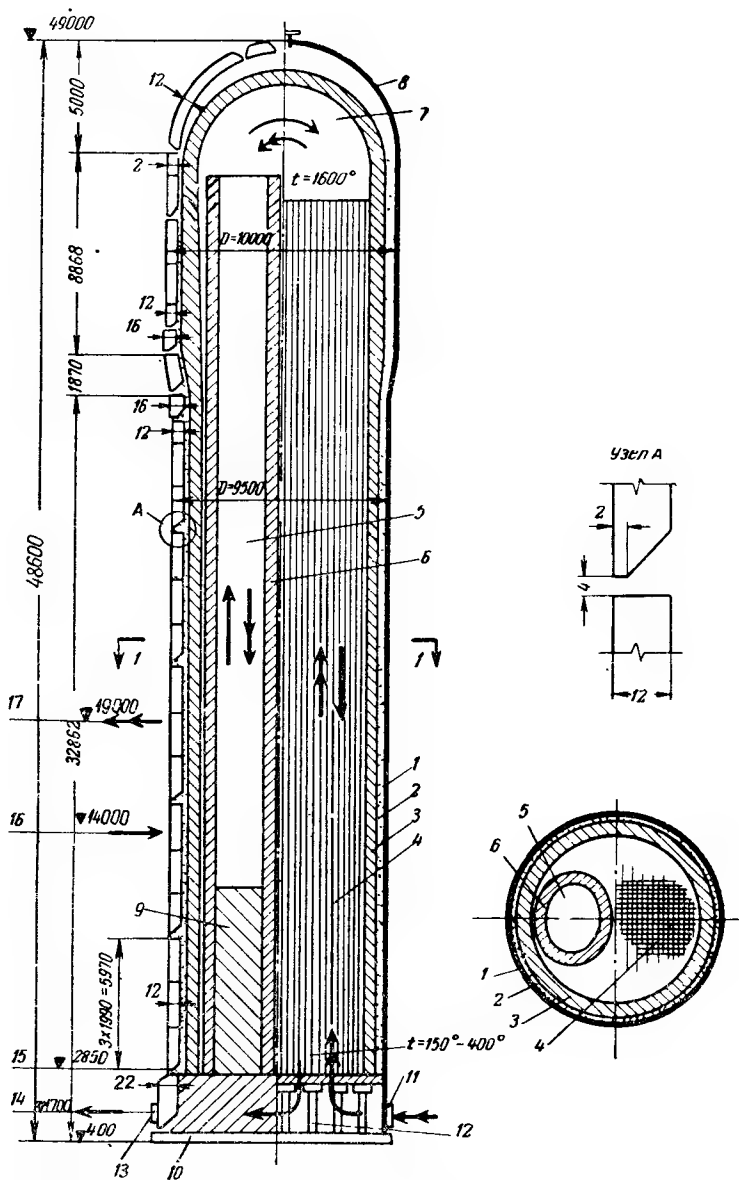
Схема устройства воздушонагревателя и геометрическая схема кожуха типовой доменной печи объемом 2700 м^3
